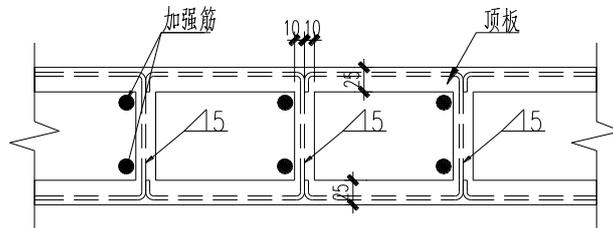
钢管混凝土束剪力墙的现场拼接加强方式
